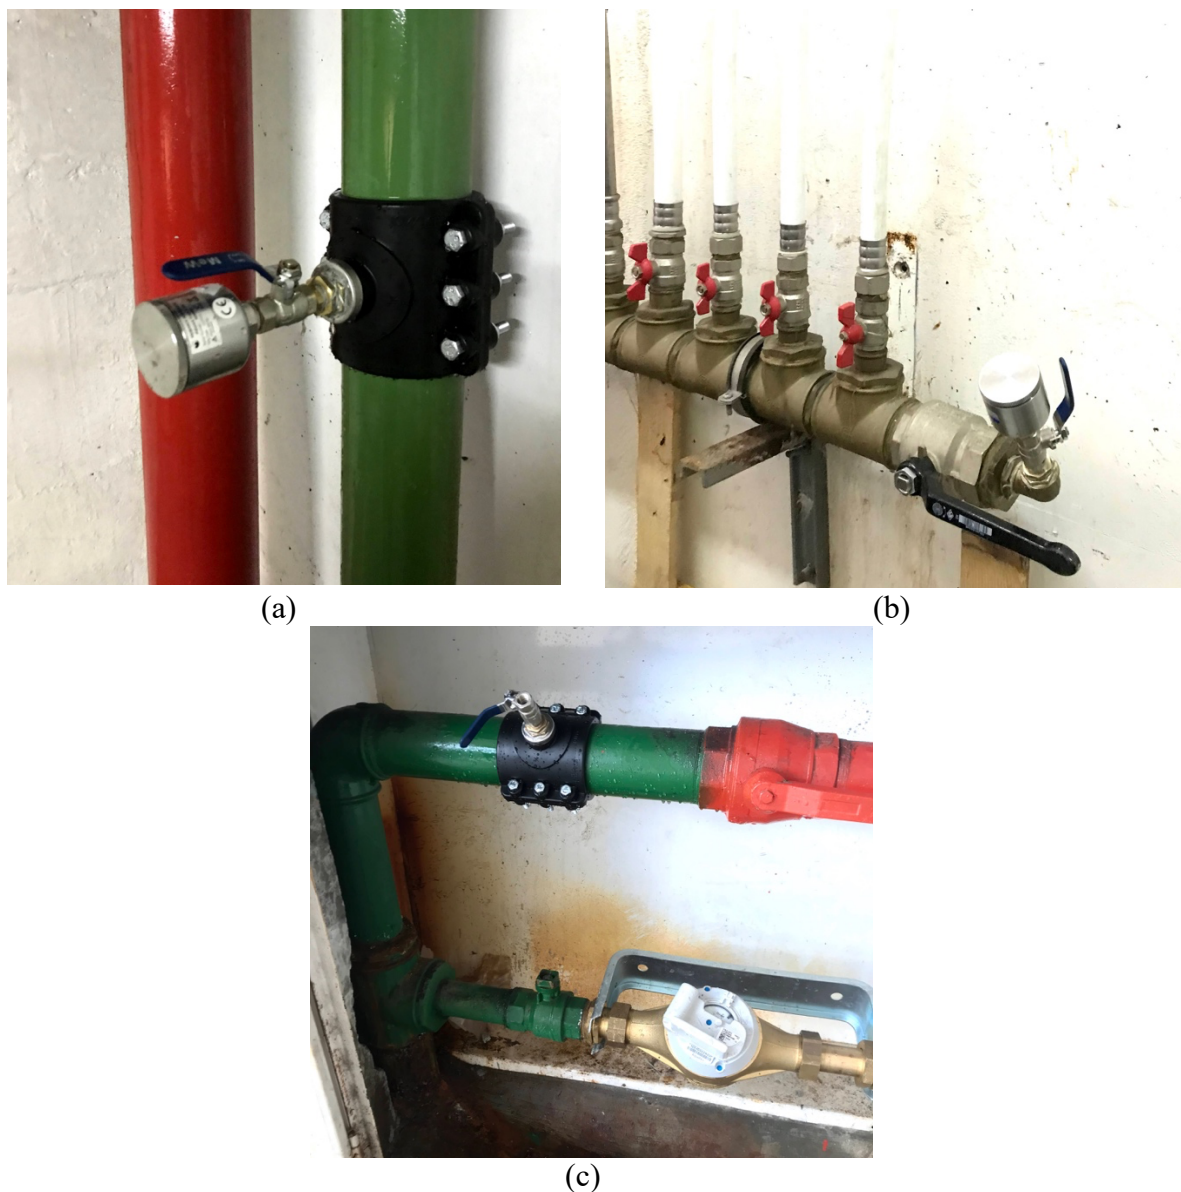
Instalação de sensor de pressão: (a) – DEC; (b) – SCFCTUC; (c) – DEI.
